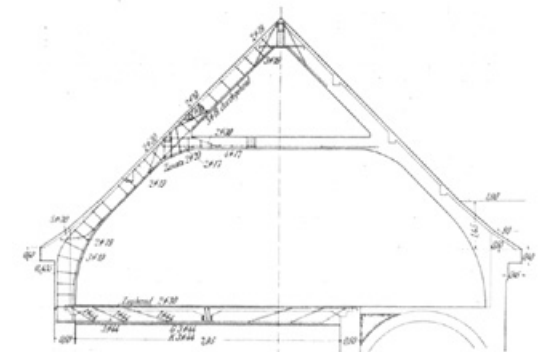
Bewehrung Dachbinder (Bosch in Beton und Eisen 1909, S. 247).
